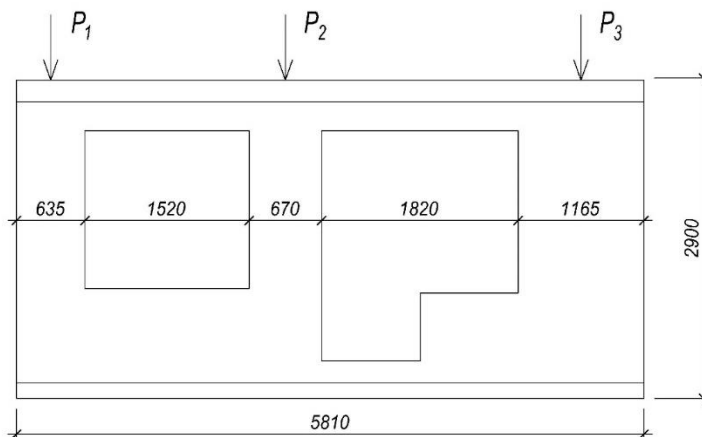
Схема приложения вертикальных нагрузок на простенки для расчета и испытания панели 10Н224квн
